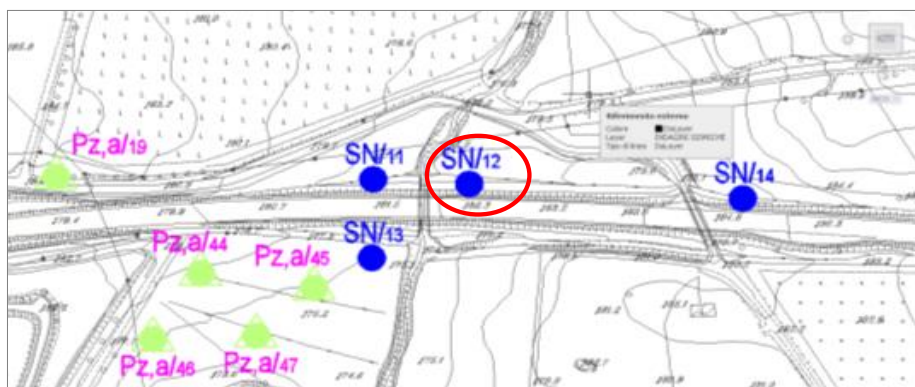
FOTO SATELLITARE CON PROIEZIONE DEL SONDAGGIO: SN12
